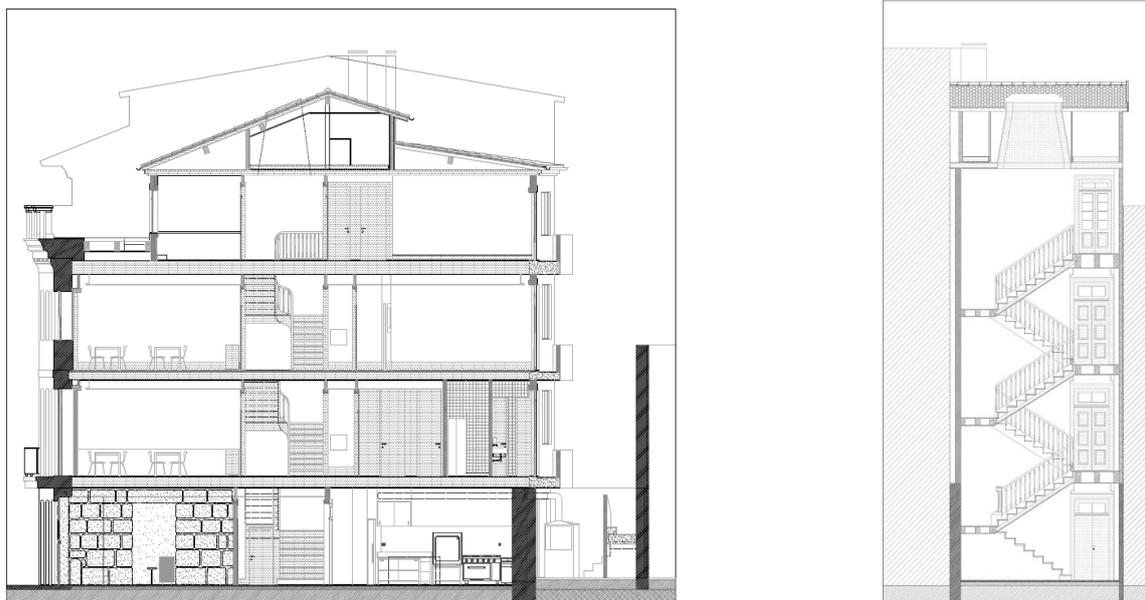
Corte longitudinal e transversal da proposta de intervenção
